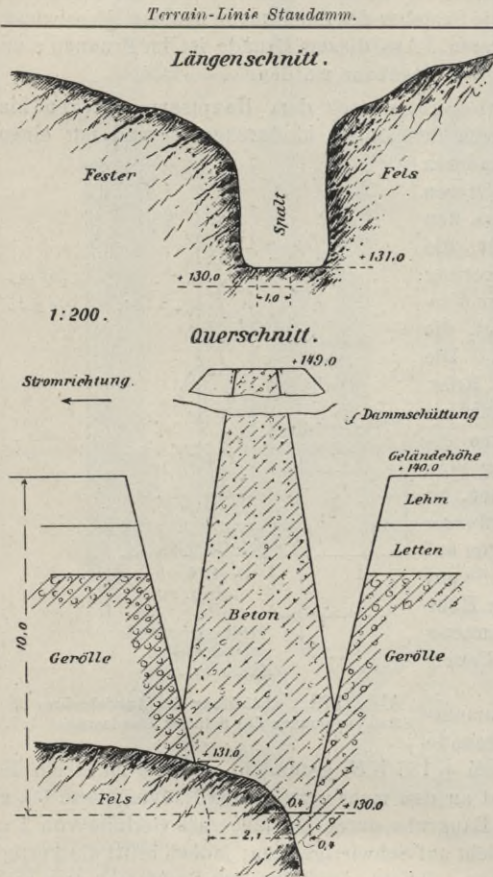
Gründung des Betonkerns im Solinger Staudamm.
